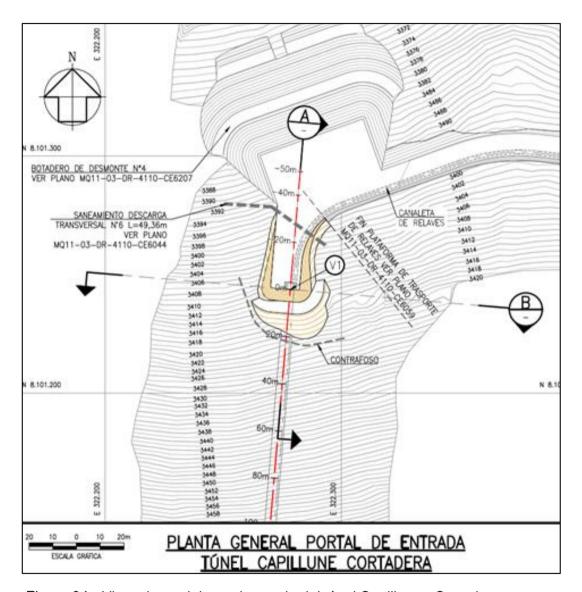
Vista planta del portal entrada del túnel Capillune - Cortadera
